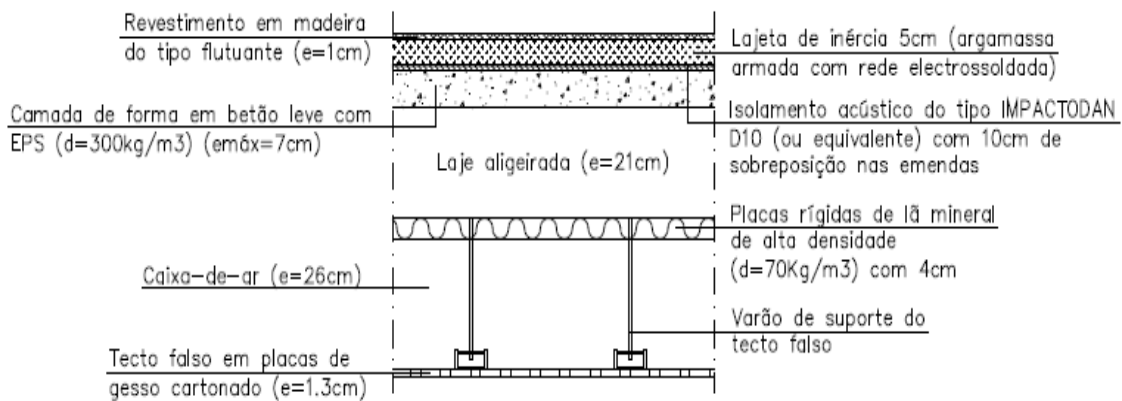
Pormenor da laje de piso entre a habitação e o comércio
